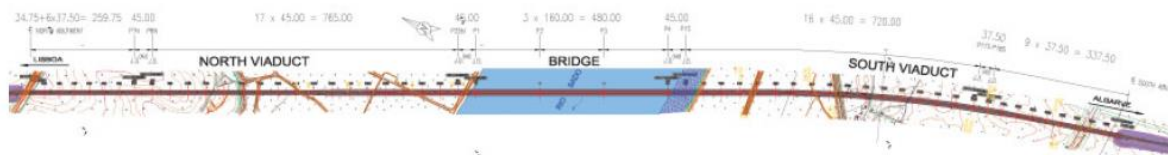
Vista em planta da ponte, adaptado de Reis, A. [et al.] (2010)
